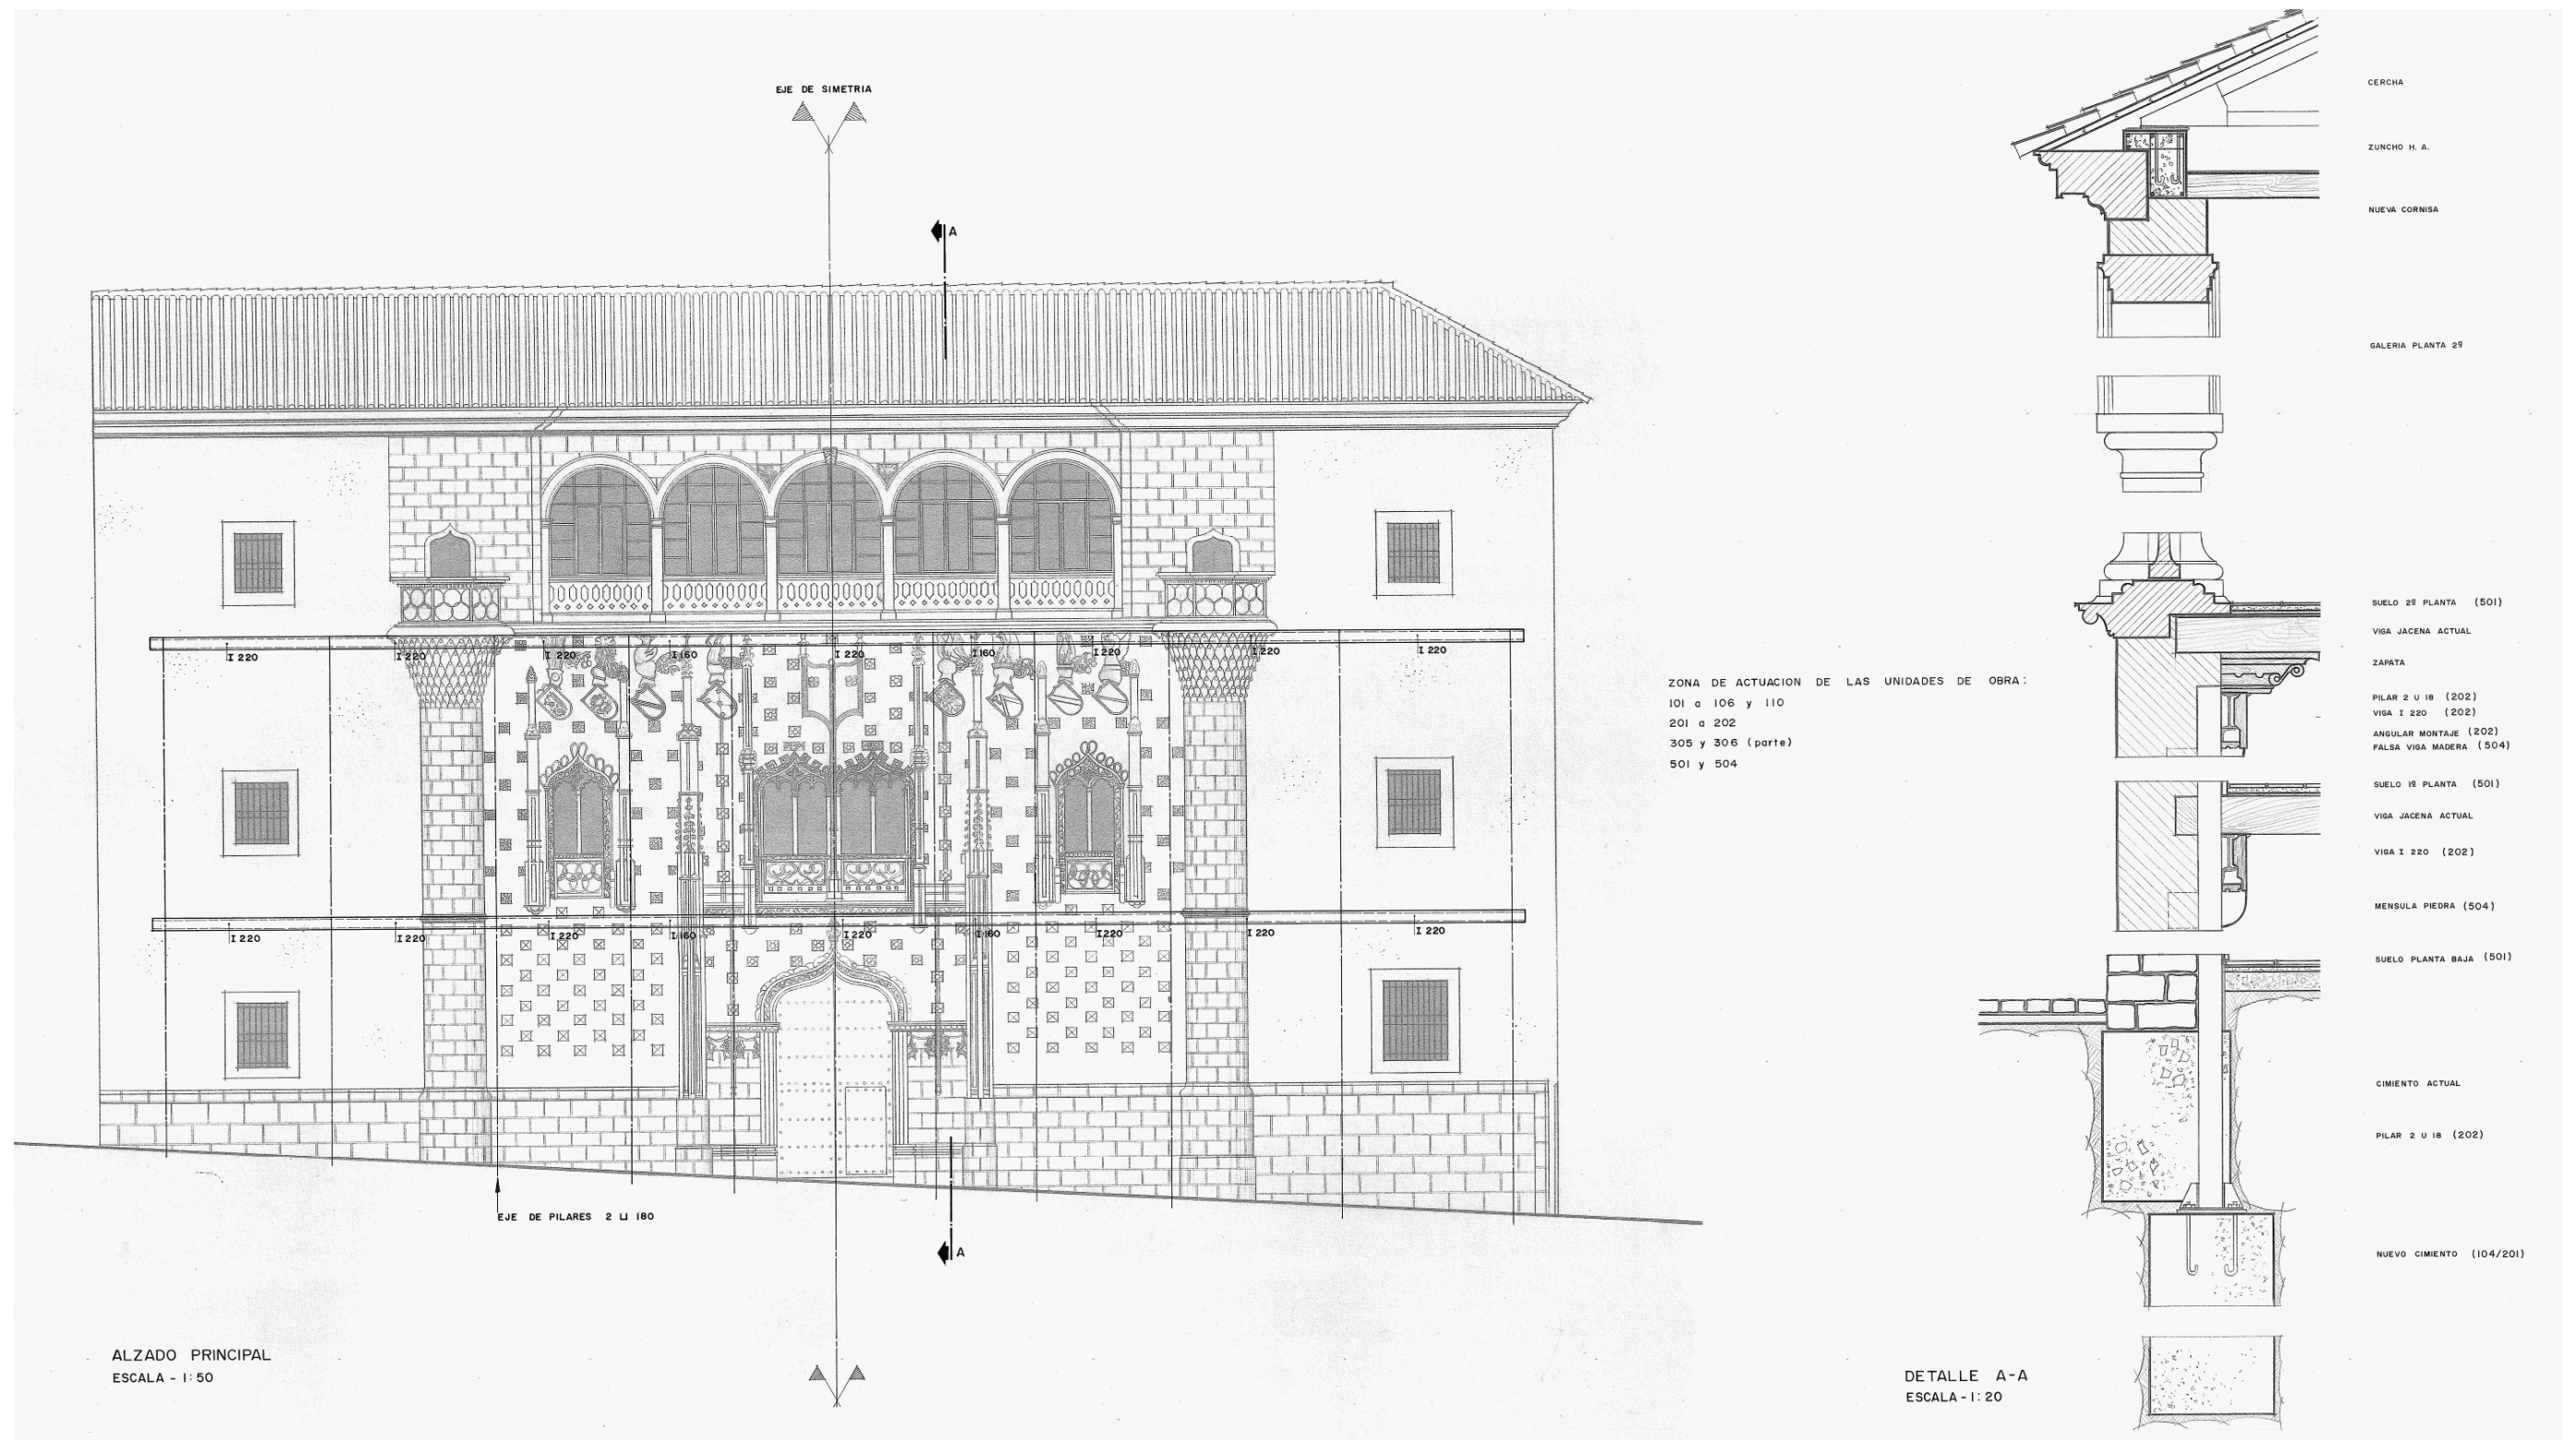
Palacio de Jabalquinto. Alzado principal y sección donde se indican los refuerzos a colocar.
